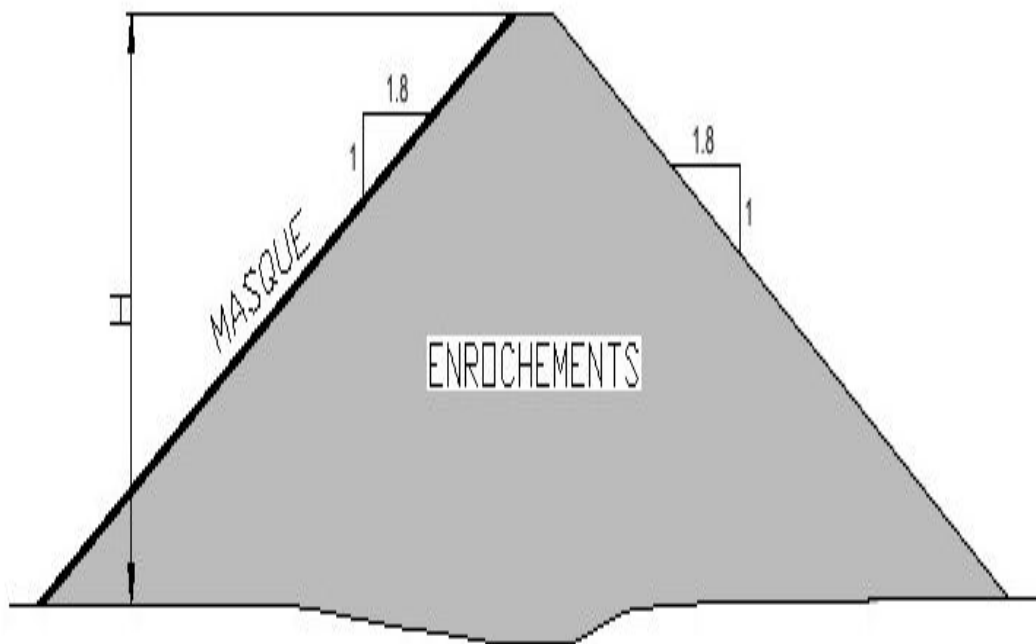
Coupe type d'une digue en enrochement avec un masque amont étanche
